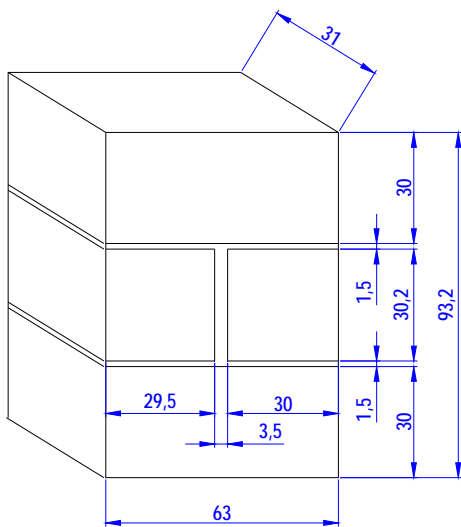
Geometría del murete de sillería arenisca ensayado. Las cotas referidas están en cm.
